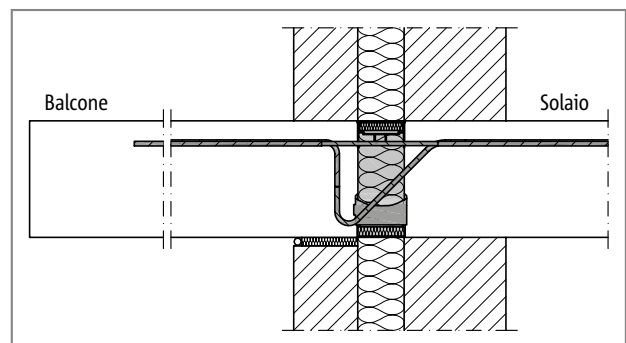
Schöck Isokorb® tipo K, raccordo con muratura bistrato con interposto isolamento
